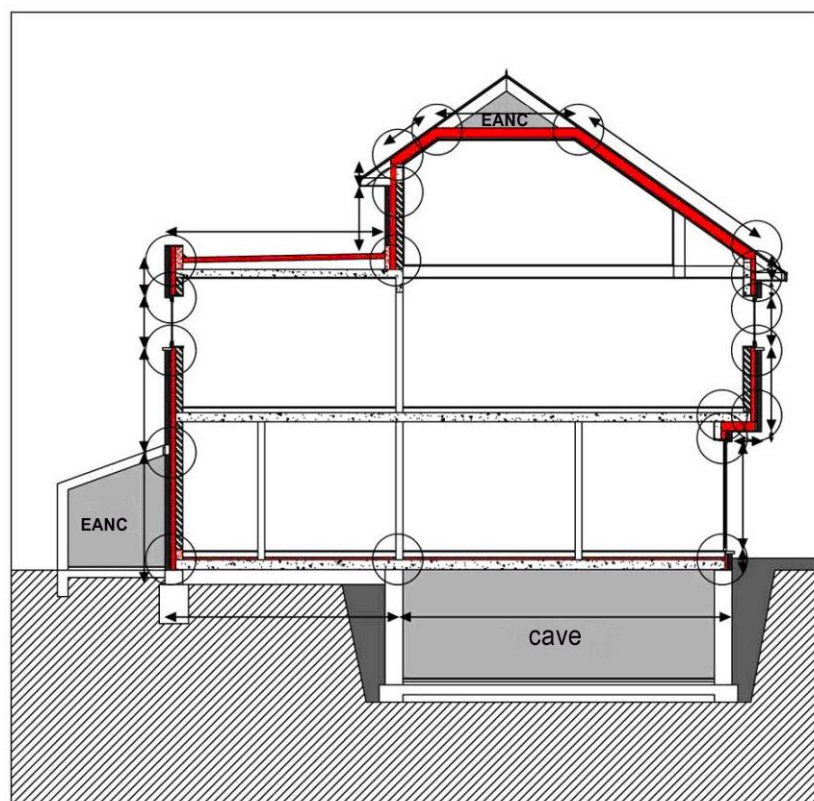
Partout où deux parois se rejoignent, on parle d'un nœud constructif linéaire.
